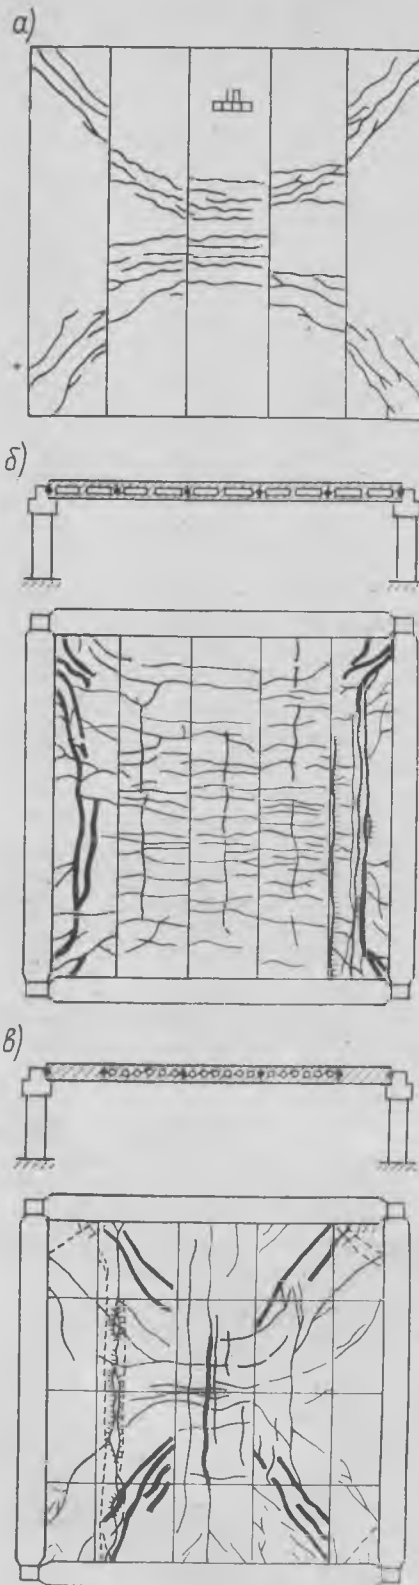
Схемы трещинообразования в перекрытиях, опертых по контуру
